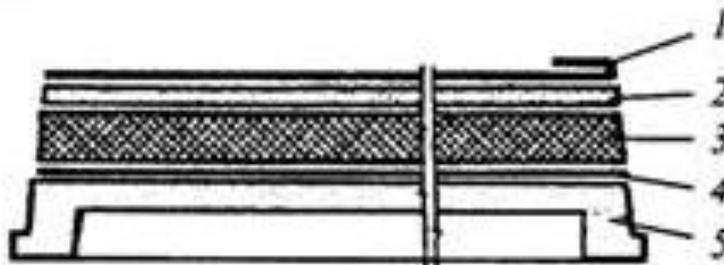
Комплексная панель покрытия повышенной заводской готовности: 1 - кровельный ковер; 2 - стяжка; 3 - теплоизоляция; 4 - пароизоляция; 5 - несущая плита
